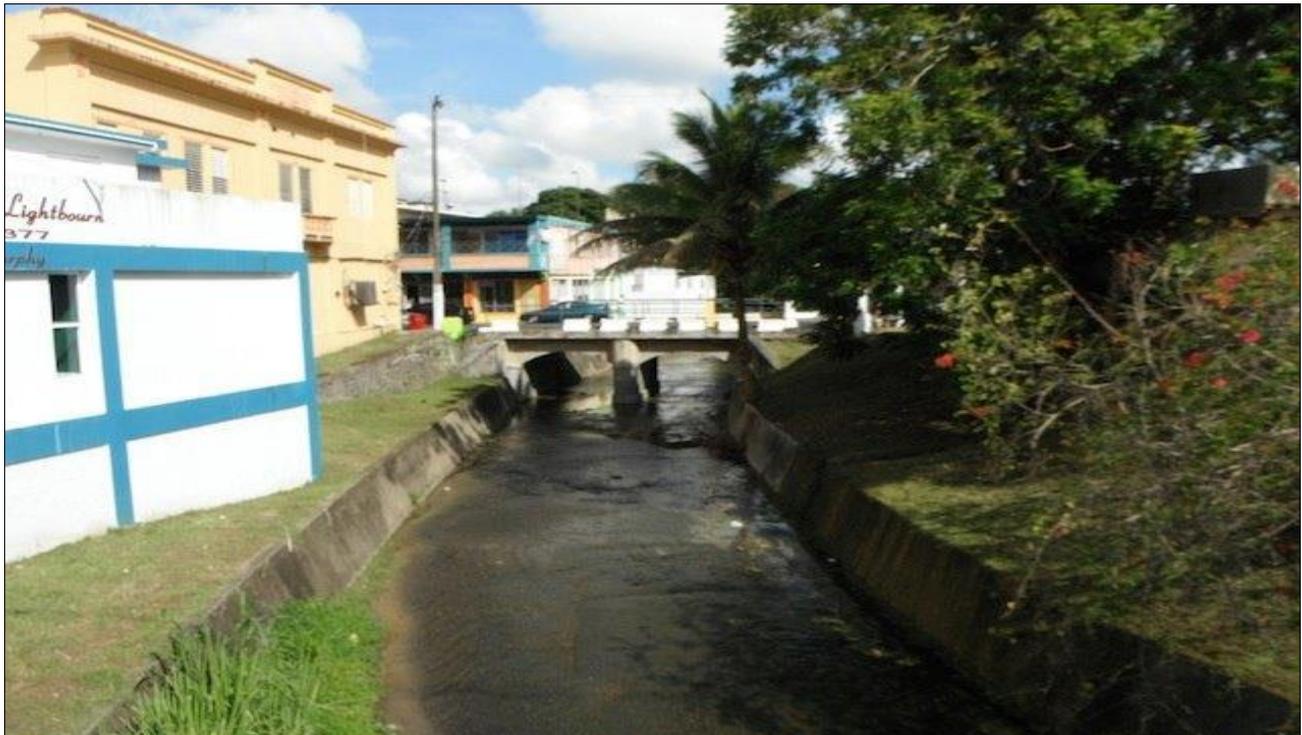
Foto de puente existente localizado en Int. Calle Núñez Romeú y PR-14
